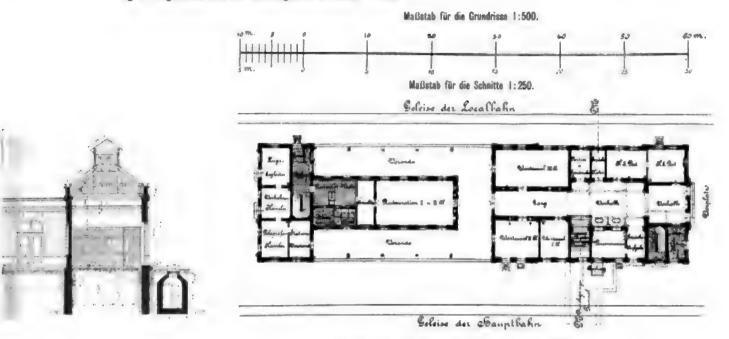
Grundriss des Aufnahmsgebäudes in Zauchtel. 1:500.
